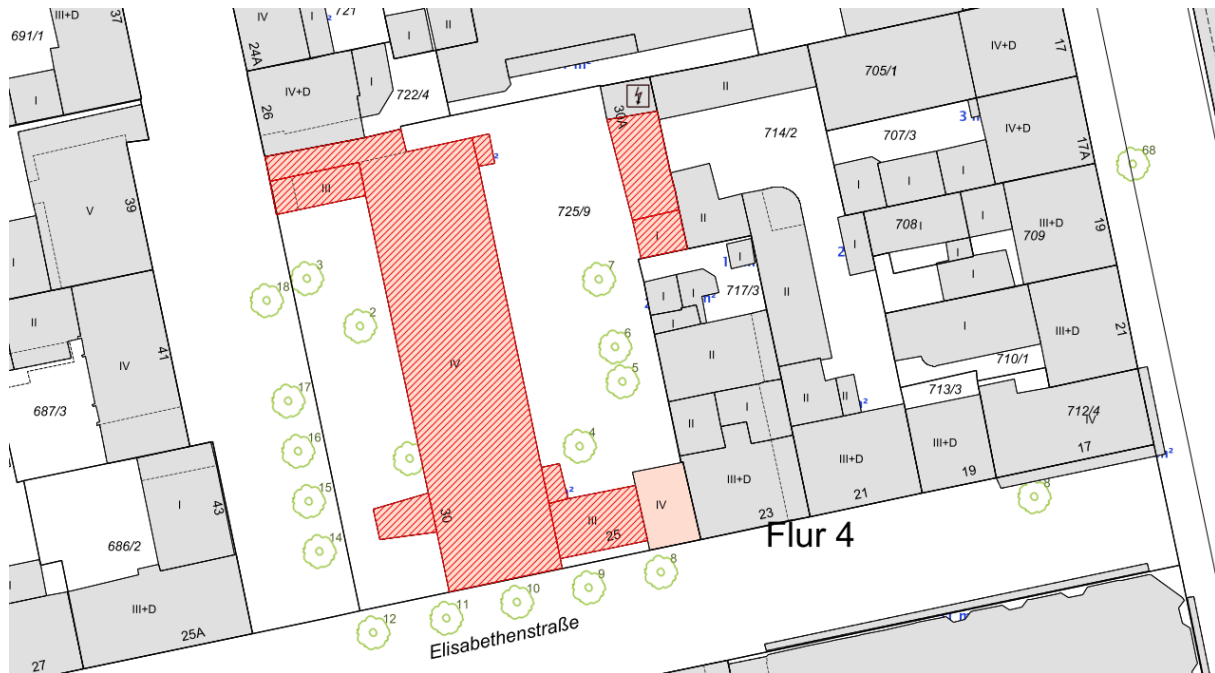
Lageplan; Stadthaus Grafenstraße 30, Darmstadt
